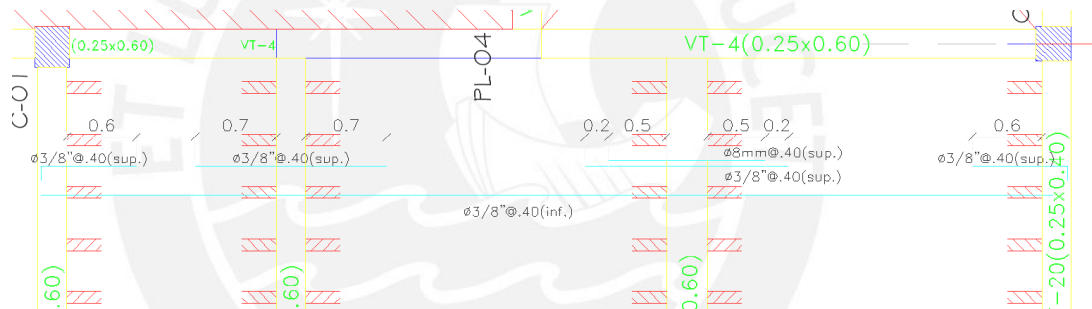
REFUERZO LONGITUDINAL ALIGERADO 20 CM.
